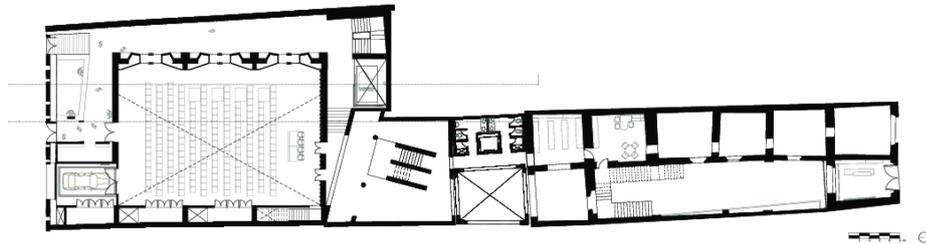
Planta Arquitectura del Museo de sitio del centro cultural de España en México.
